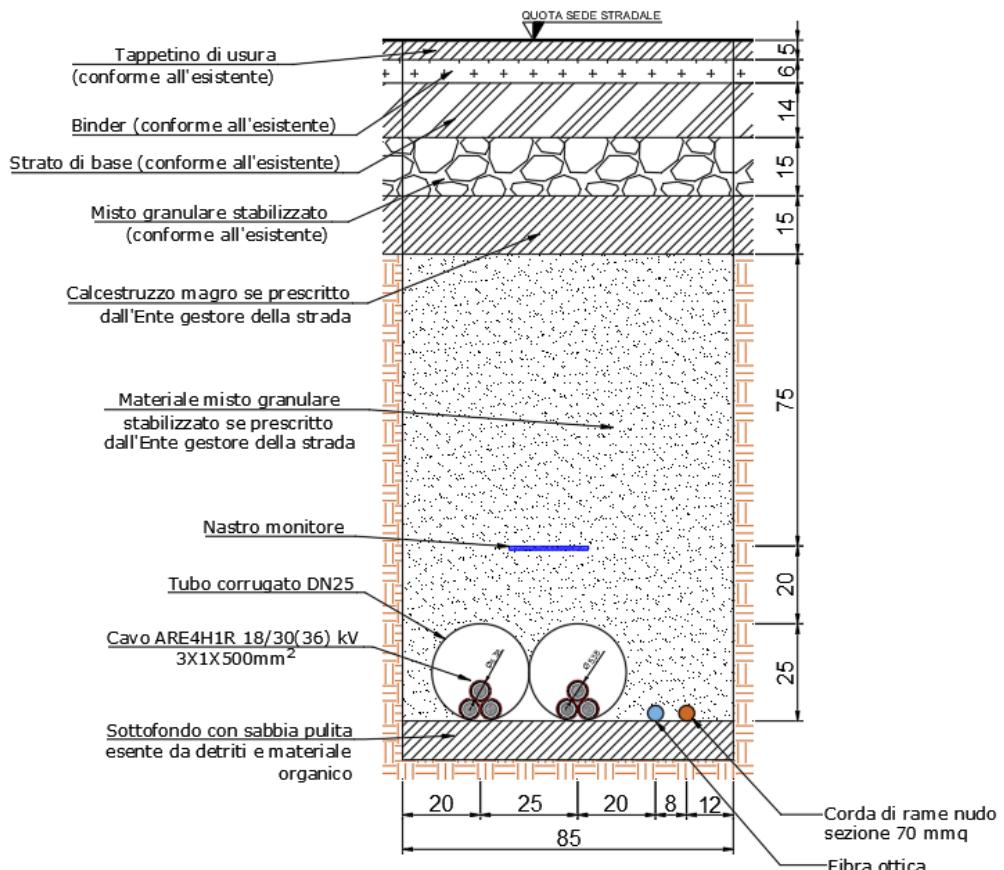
Tipico di sezione cavidotto MT su strada asfaltata
